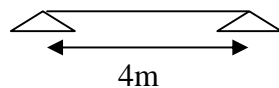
Schéma statique du 3ème type de poutrelles.
